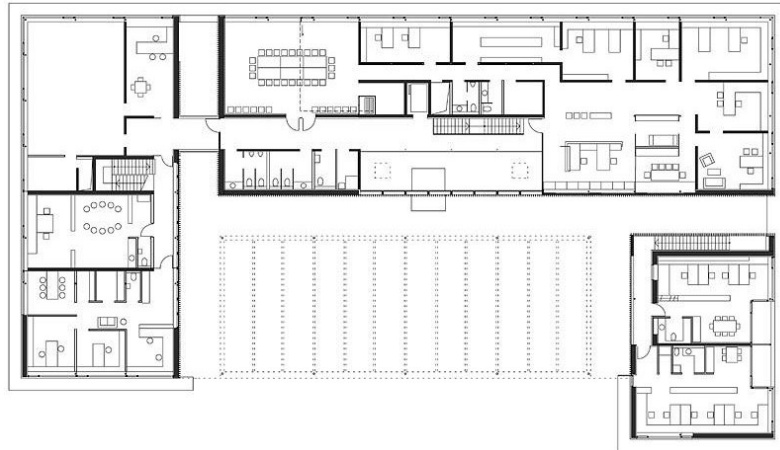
pianta piano primo del centro della comunità di Ludesch
